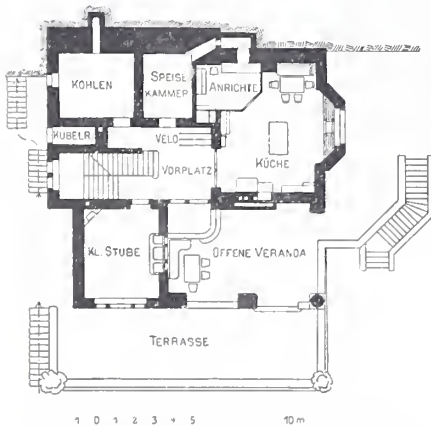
Grundriss vom Untergeschoss. Masstab 1 : 400.
